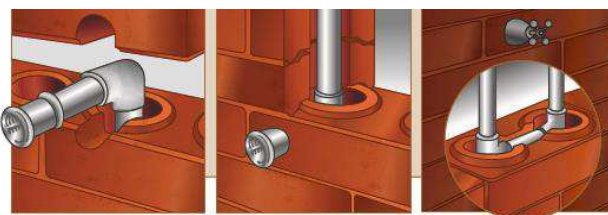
Instalações hidráulicas em tijolos de solo-cimento.
